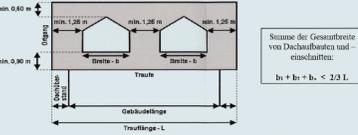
Abmessungen zulässiger Dachaufbauten (hier Beispiel: Satteltäube)
